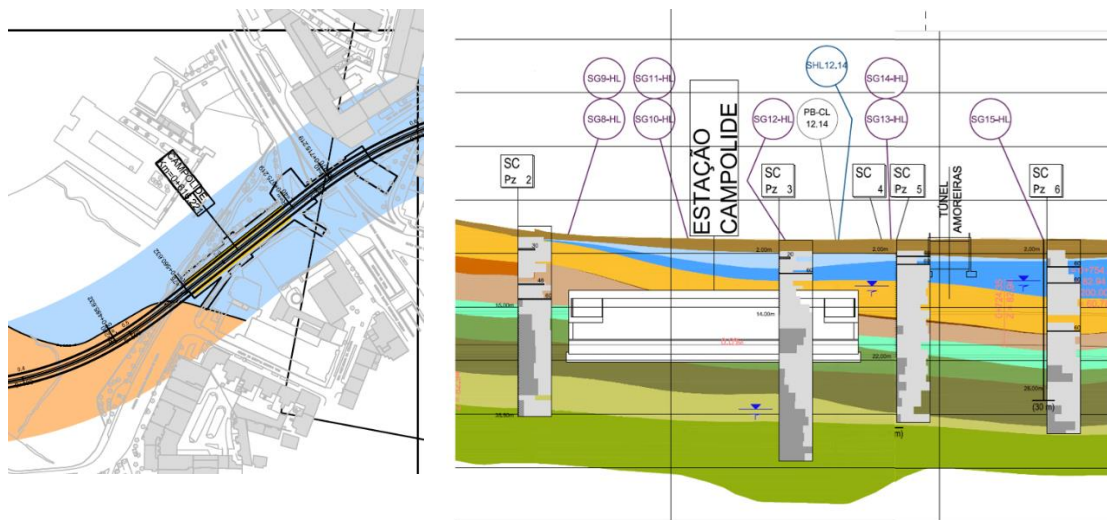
Planta e perfil longitudinal – Geologia / Geotecnia
